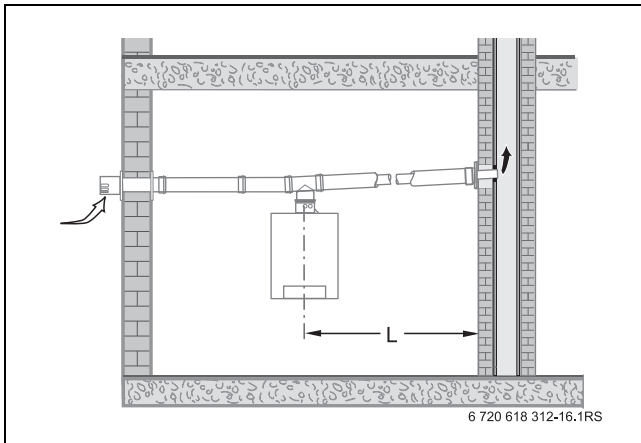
C_{83x}: Abgasanschluss an feuchteunempfindlichen Schornstein (Unterdruckbetrieb); Verbrennungsluftzufuhr über Fassade
